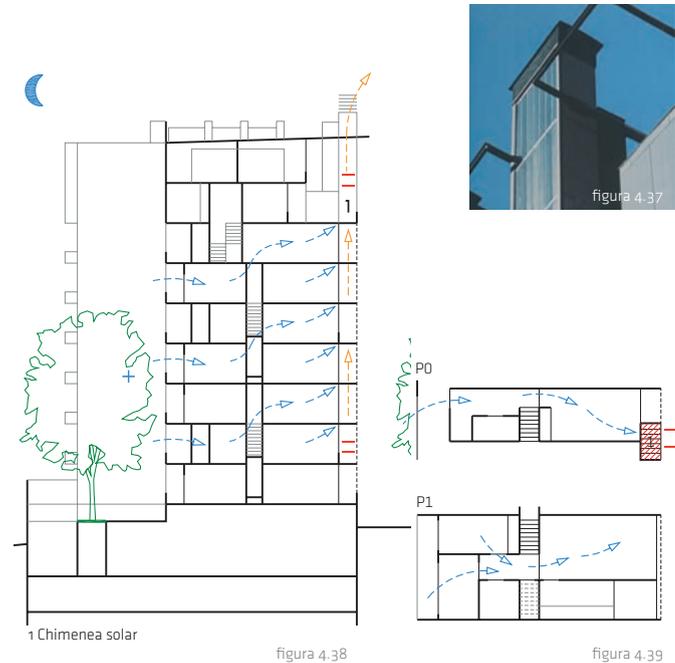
4.40. Edificio de viviendas EMV. Chimeneas de extracción. Madrid. AUIA. 2003
